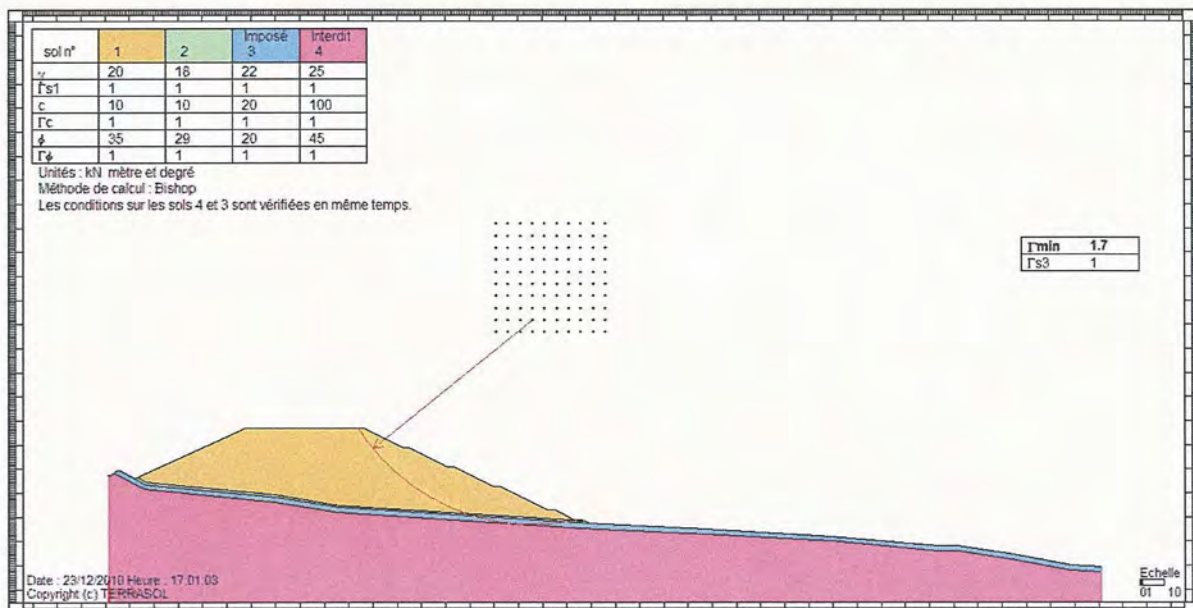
Coupe 2 : Stabilité vis-à-vis d'un glissement profond
